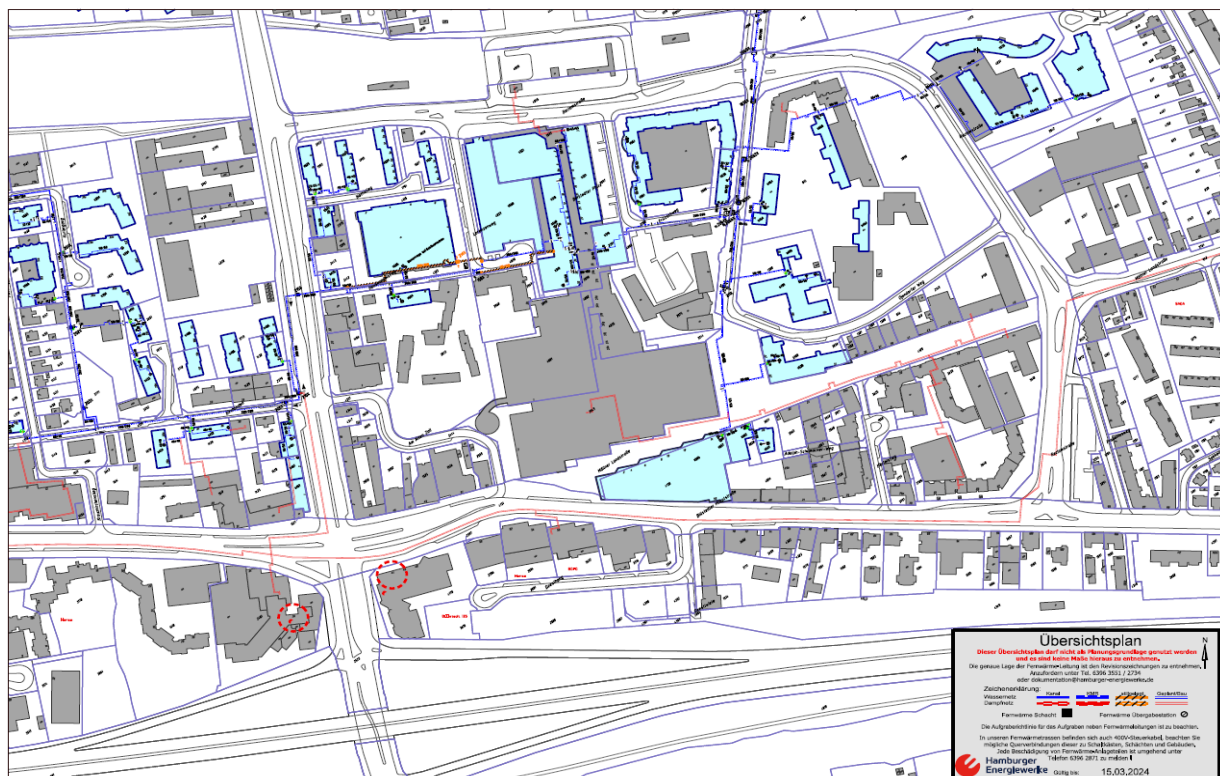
Übersichtsplan Bestand und Planung Fernwärme (© Hamburger Energiewerke; 15.03.2024)
